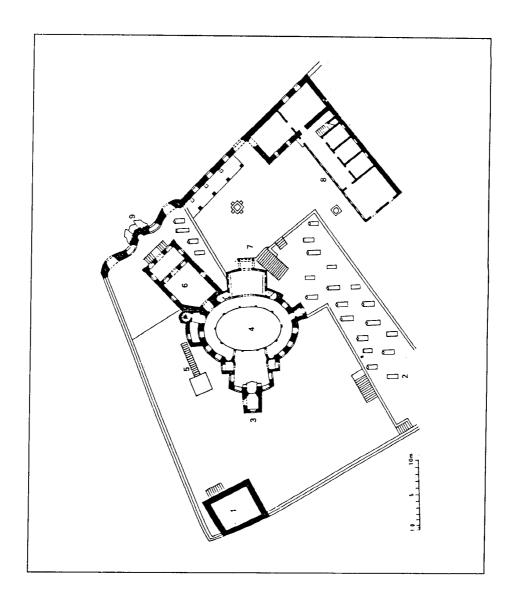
مسقط أفقي لمسجد ومدرسة زال محمود باشا ضمن مجمعه (كليته) في إستانبول (عن : Sözen) .
